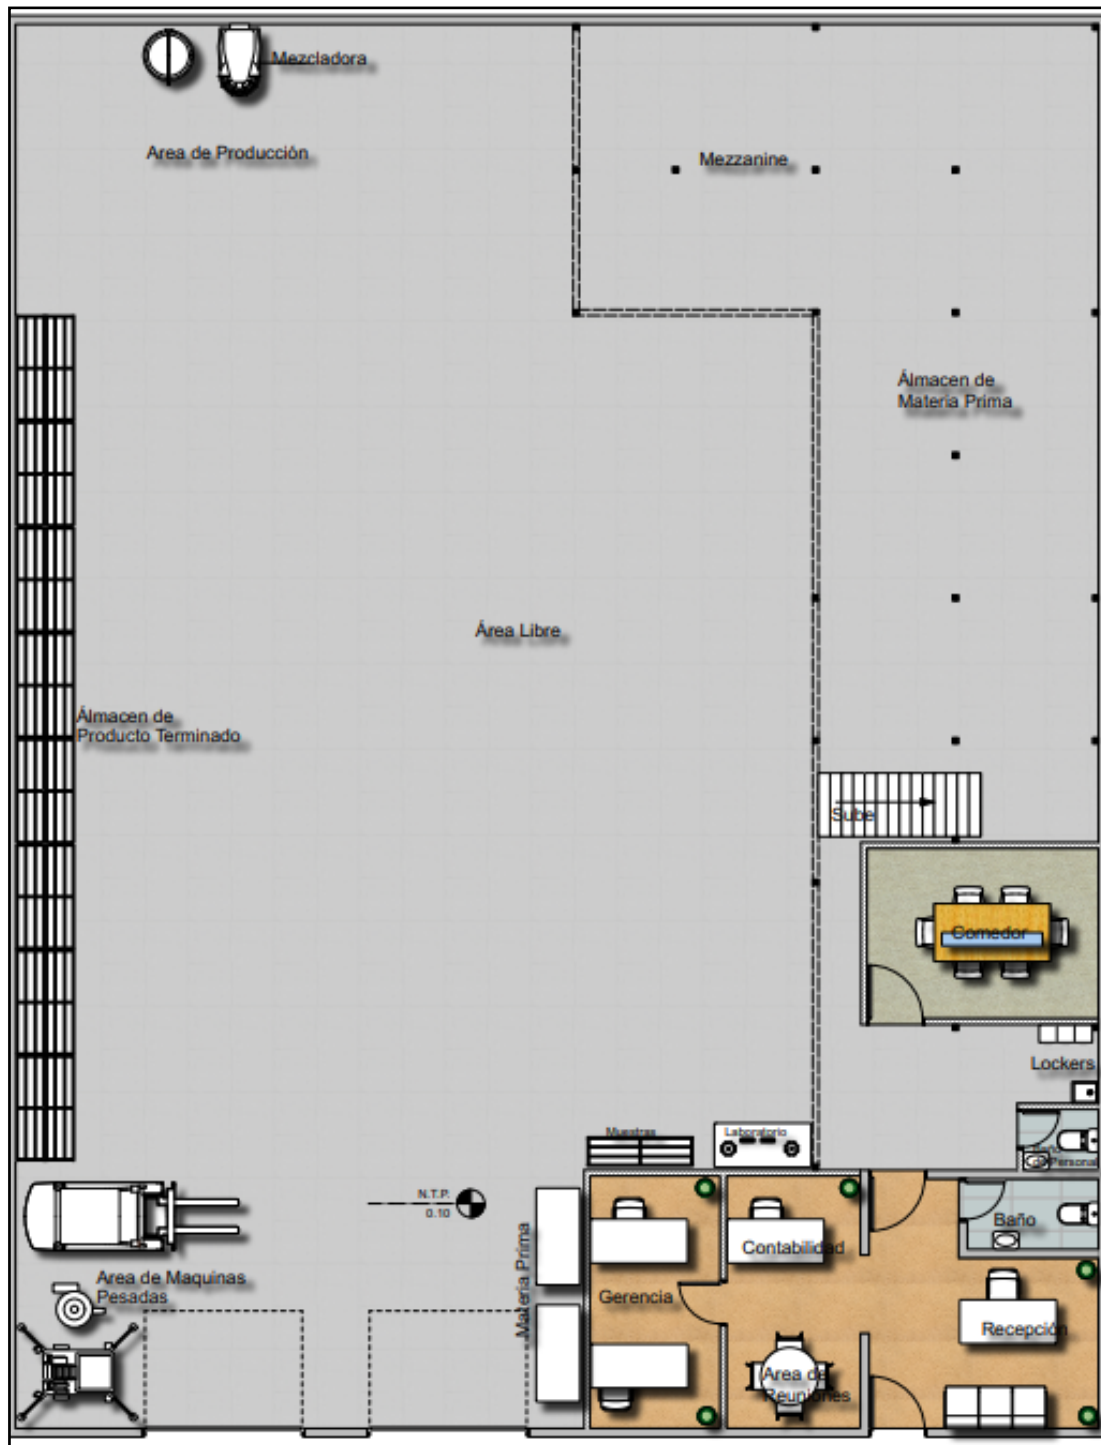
Planta Arquitectónica de la Instalación Few Group. Primer Nivel.
